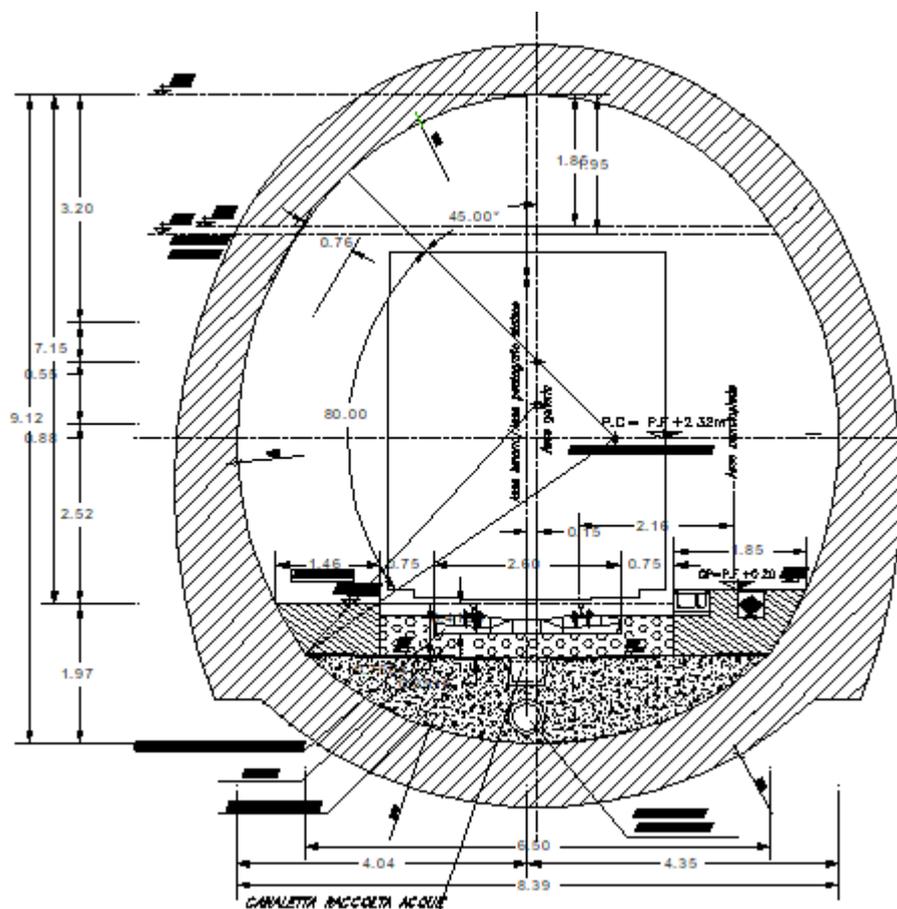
Sezione di scavo in tradizionale – Soluzione di Progetto Esecutivo
